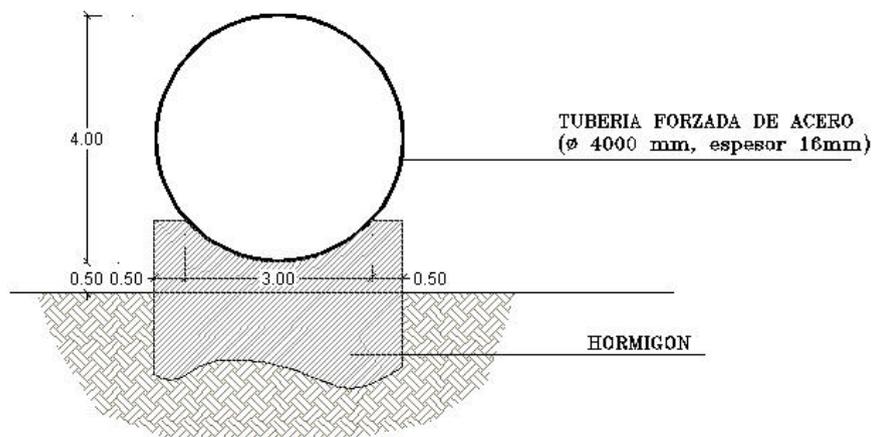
Vista en corte de la Cañería a la vista
